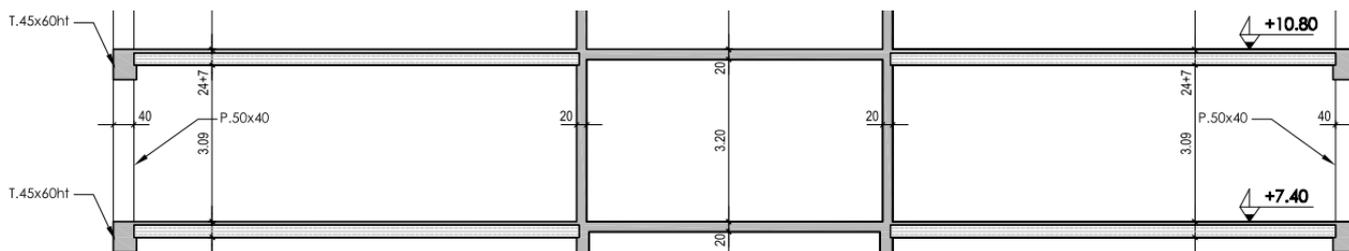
Schéma en coupe d'un étage courant du bâtiment béton
